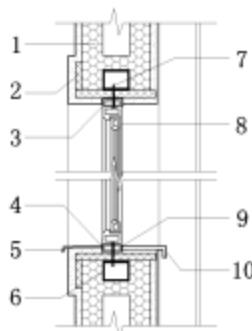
门窗框与墙体芯肋连接及保温防火组合构造示意
